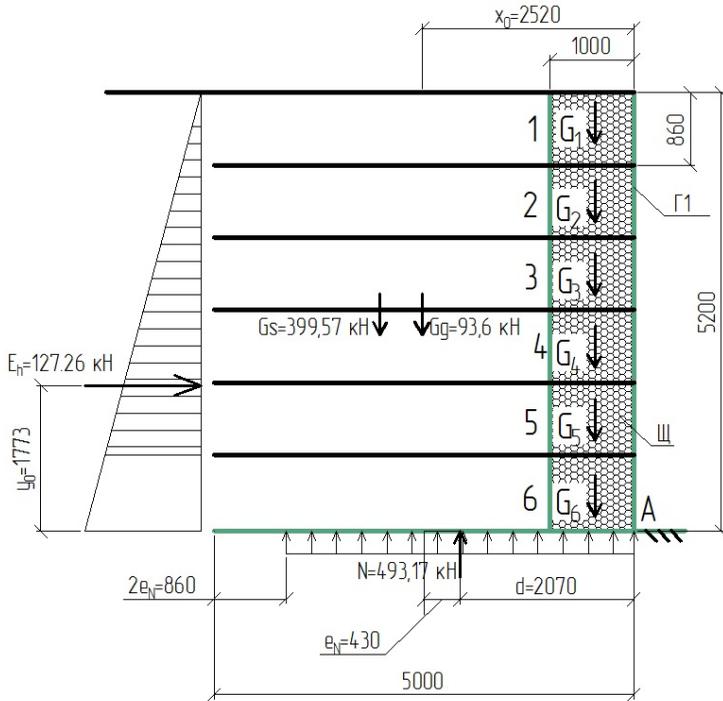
Схема к расчету устойчивости подпорной конструкции против опрокидывания
